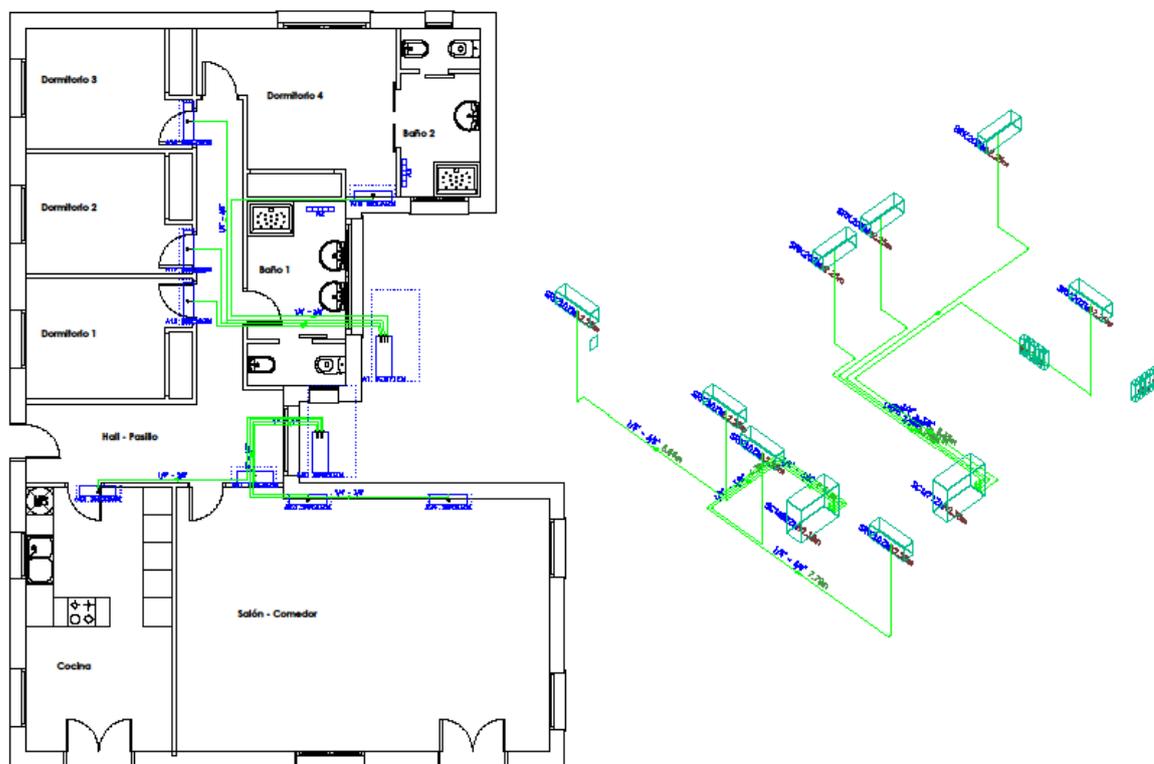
Plano y esquema de planta con instalación con bomba de calor
